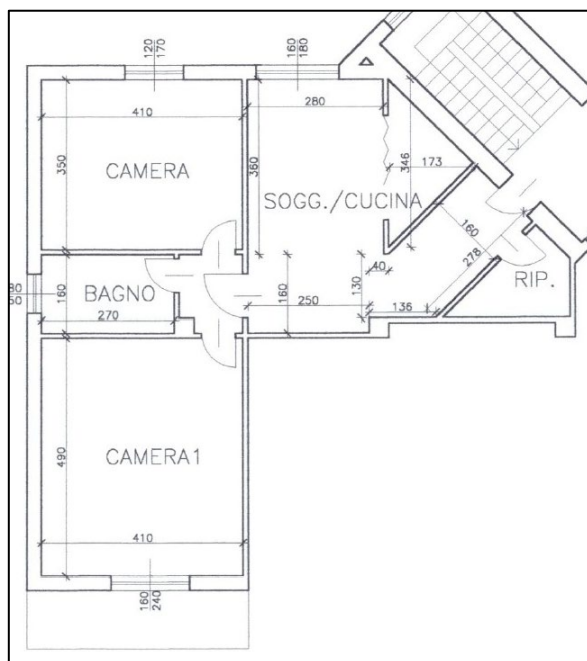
Planimetria Art. 26 del 17.01.2001
